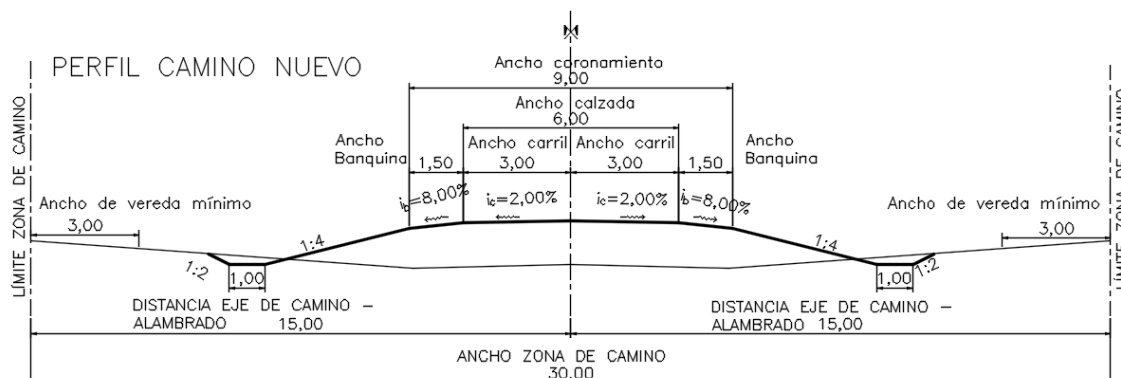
Perfil transversal tipo. Fuente: Elaboración propia.
